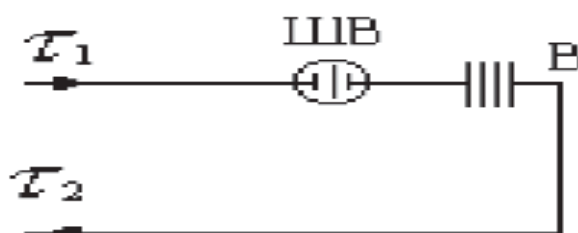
Схема местного теплового пункта с вентиляционной нагрузкой
